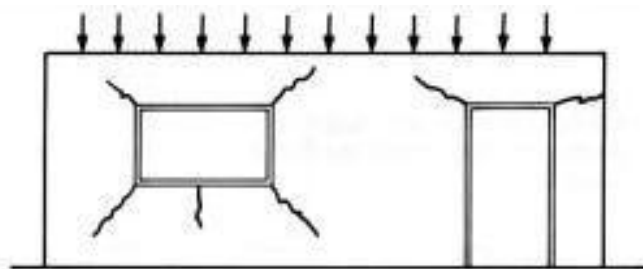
Fissuras causadas por sobrecarga vertical uniforme em paredes com aberturas.
